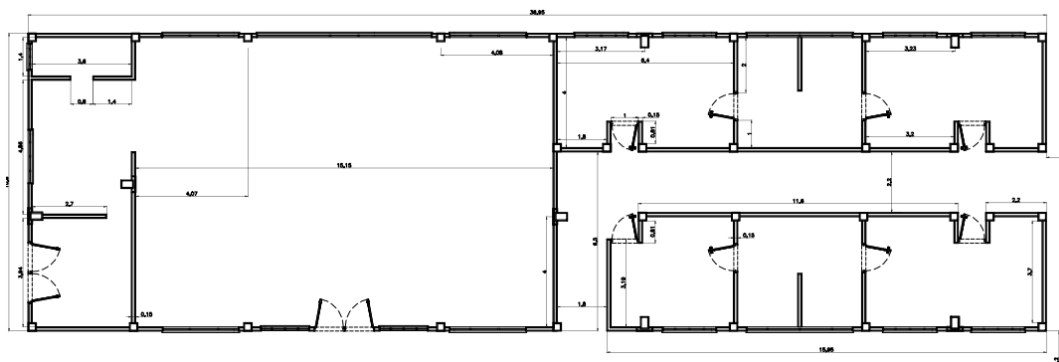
Planta Arquitectónica del Bloque No. 1 (Bloque de Estudio)
